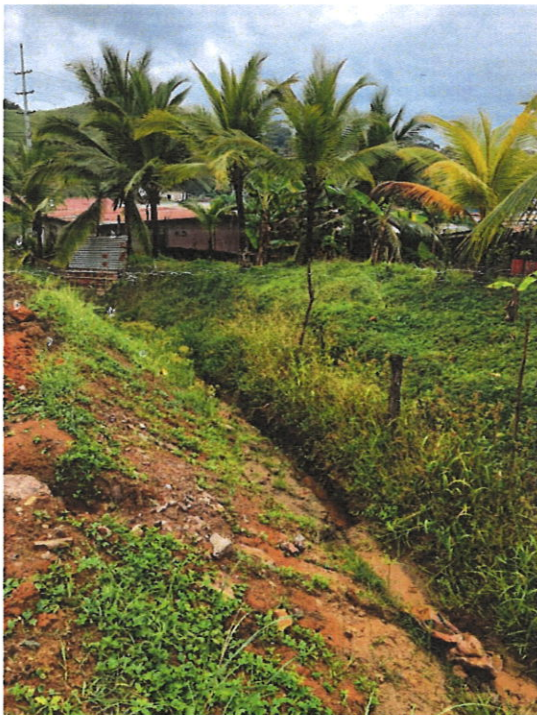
Vistas de parte del canal que divide la barriada San Pedro B, del proyecto residencial.
